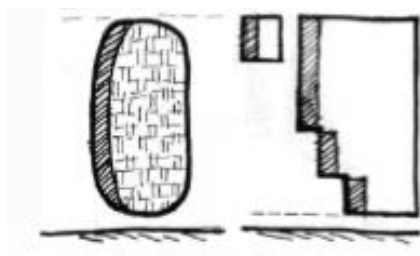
Planta Vivienda Campesina. Recinto - Fuente: Elaboración propia
